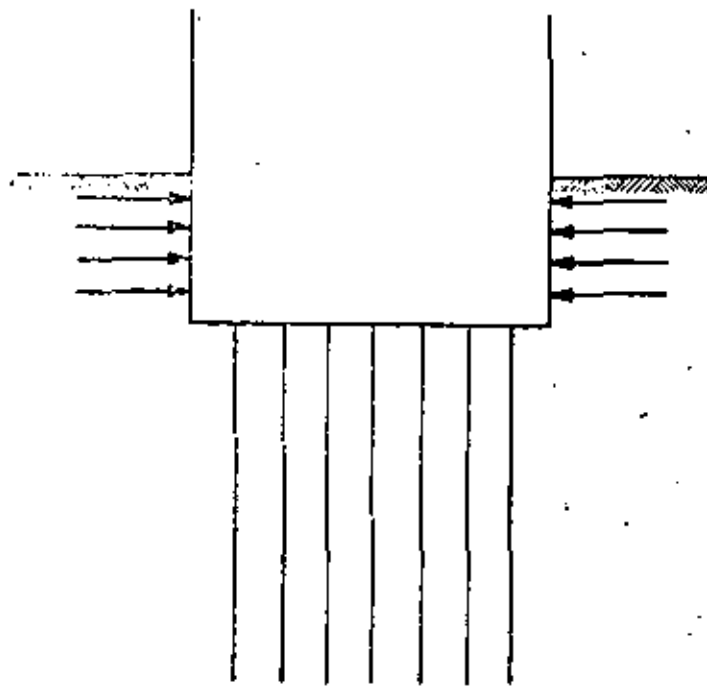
Encojonamiento de la cimentación para absorber las fuerzas horizontales producidas por la superestructura
